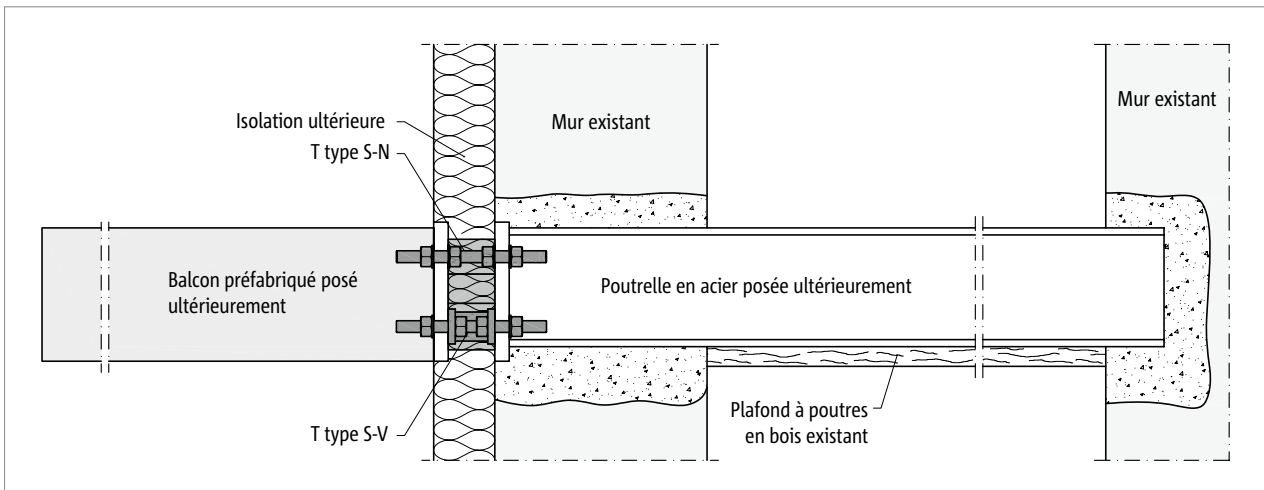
Schöck Isokorb® T type S-N et T type S-V : balcon préfabriqué en porte-à-faux libre posé ultérieurement ; raccordé à des poutres en acier installées ultérieurement ; vissage intérieur
